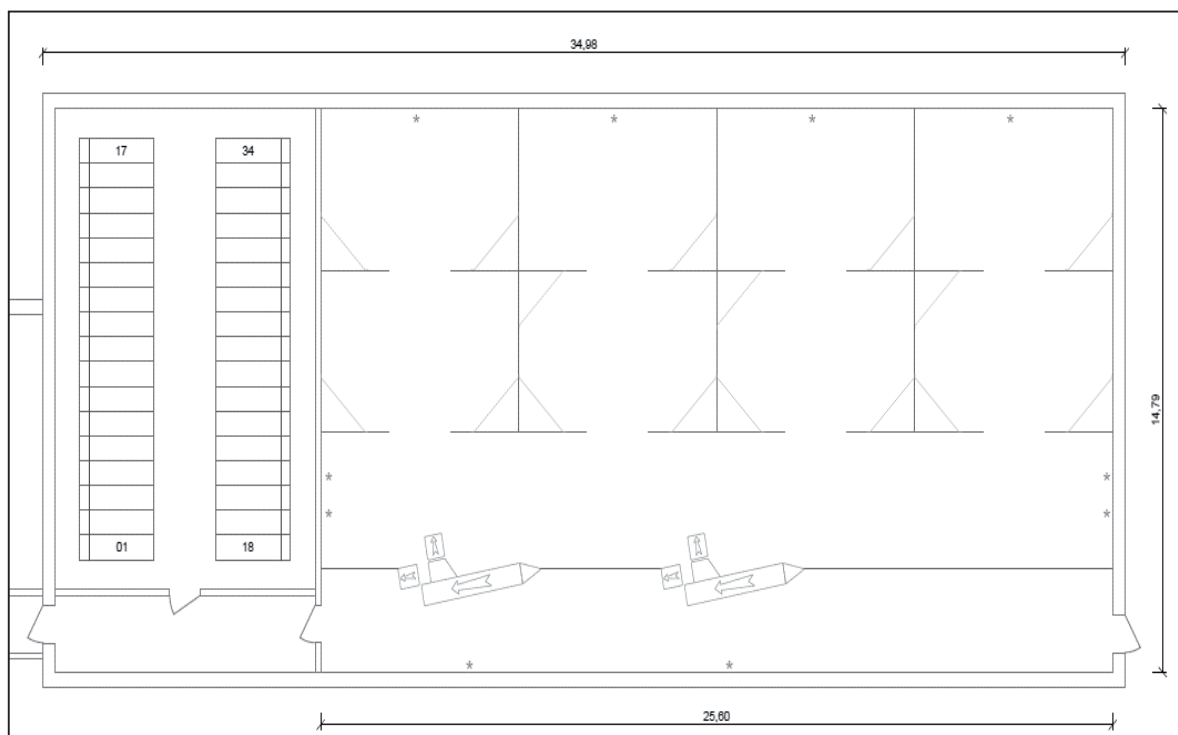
Grundriss des Wartestalles mit Abrufstationen CallMatic auf Betrieb A
